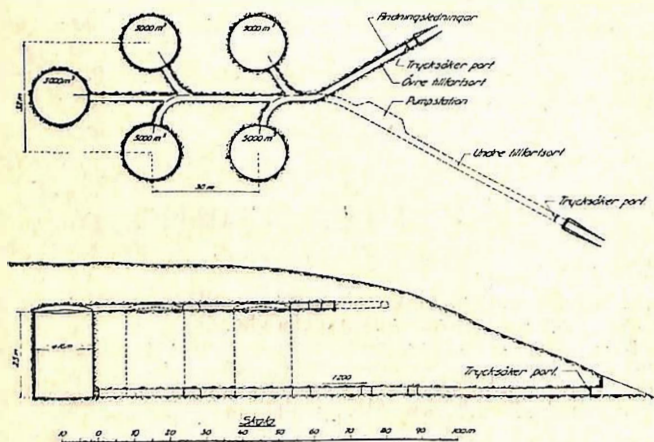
Plan og lengdesnitt av plate-betong-tankanlegg.
